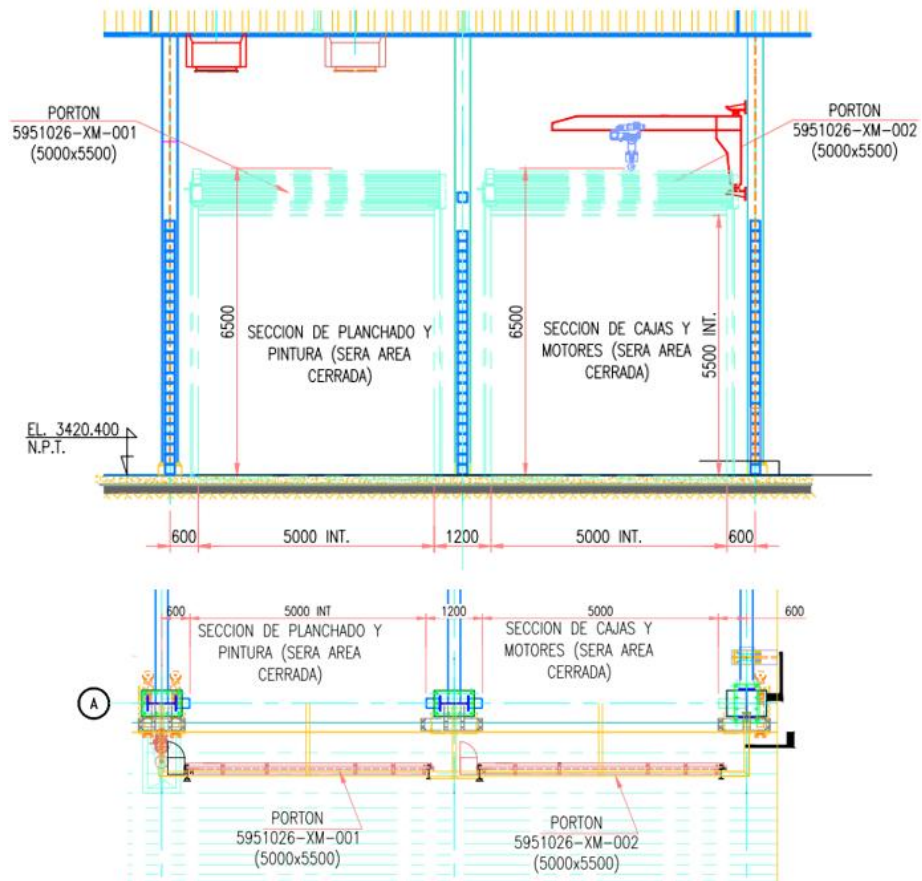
Propuesta de marco estructural por fuera para instalación de portones
